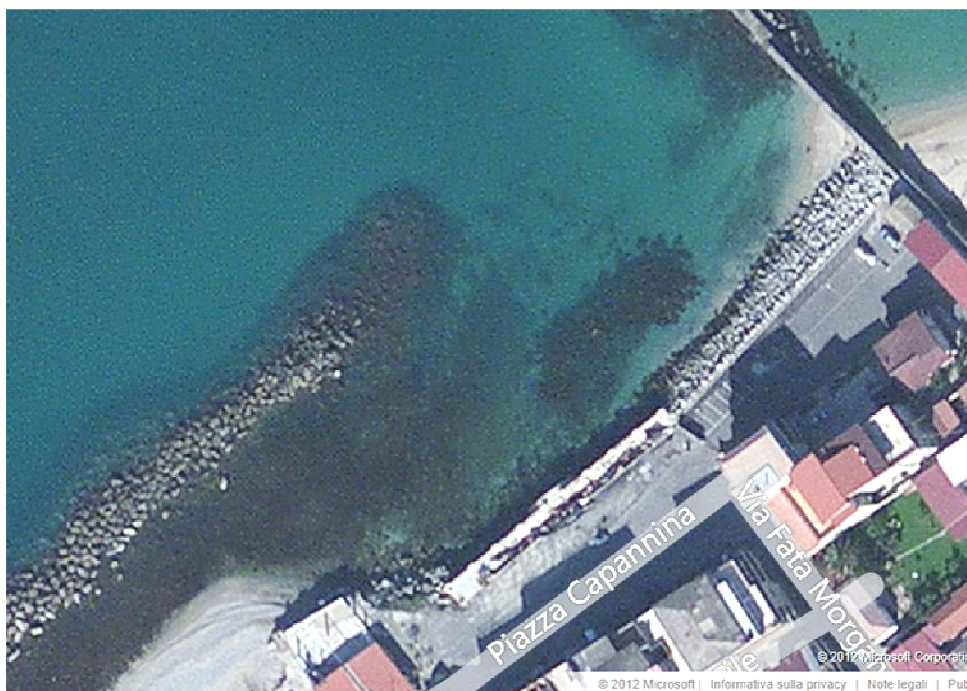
l'area Piazza Capannina in forte erosione, i tratti di spiaggia a Est e ad Ovest rispetto alla struttura muraria oggetto d'intervento risultano fortemente ridotti
